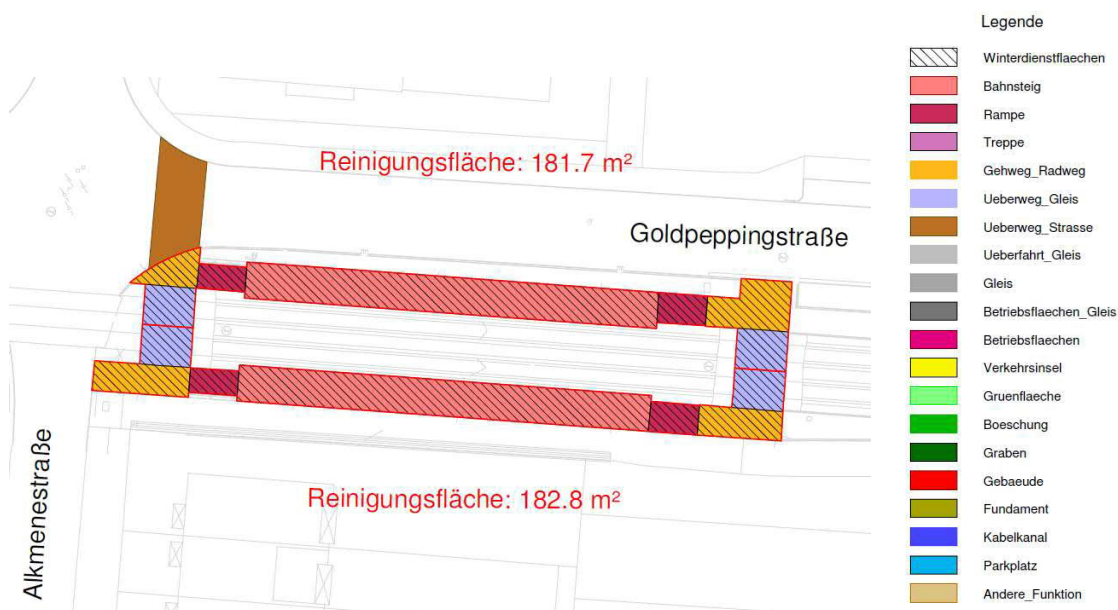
Detailausschnitt der Haltestelle Alkmenestraße und Legende
